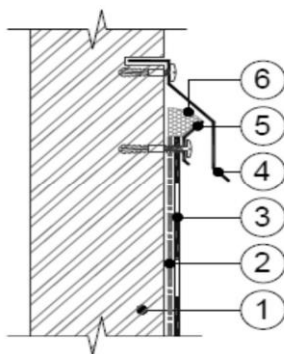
Примыкание кровли к стене с механическим креплением края кровельного ковра
